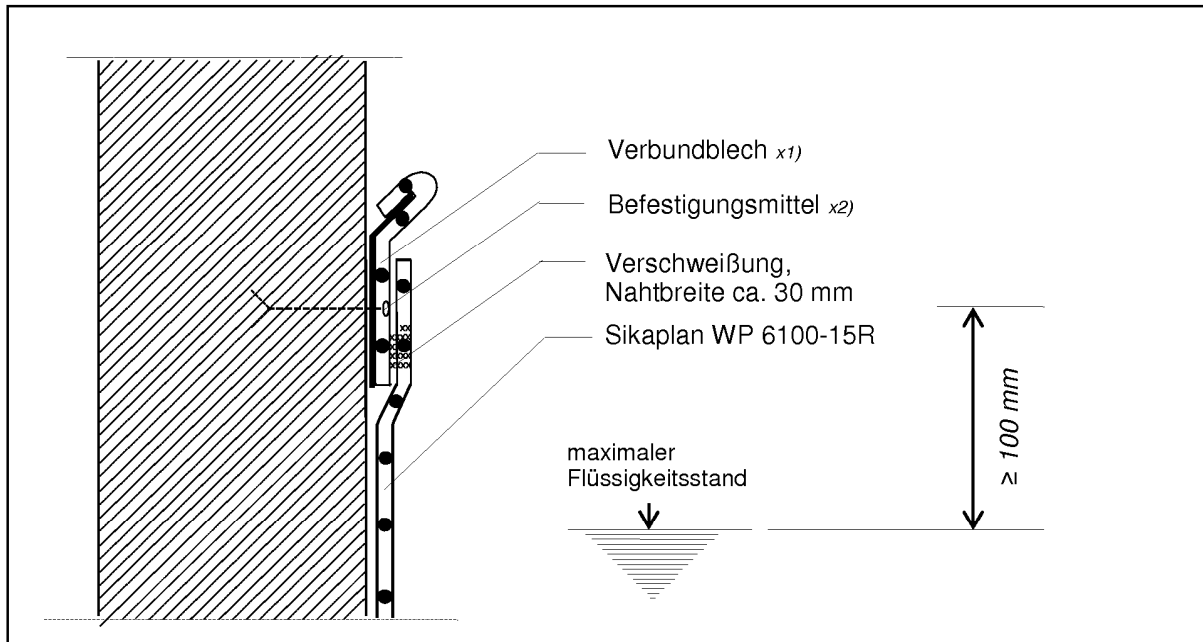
Randverwahrung mit kaschierten Blechen (Verbundblech, Detail A)
